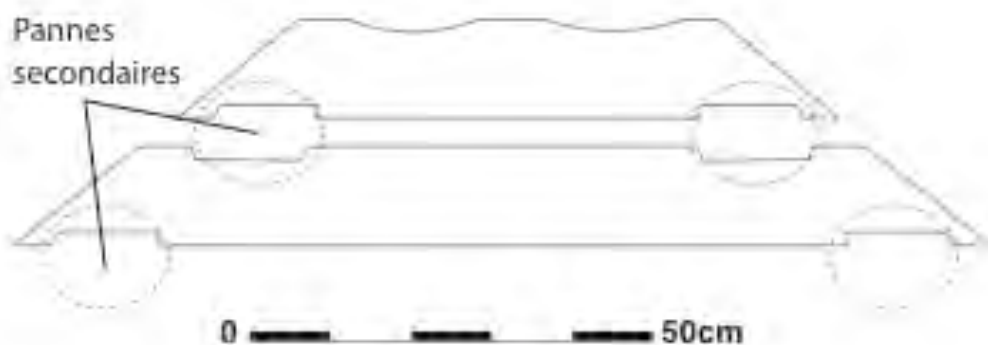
Détail d'un assemblage à mi-bois de mailles empilées et de pannes secondaires (bâtiment CBO400).
